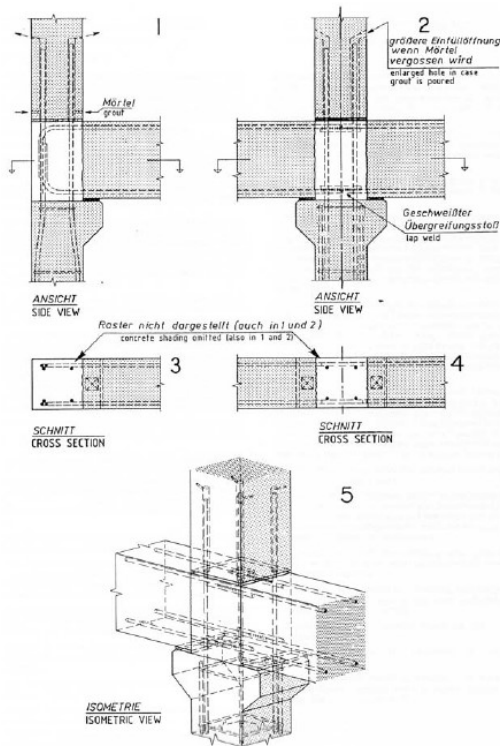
Interrupção de pilar com ligação por armadura e betonagem integral do nó (Stupré, 1981)
